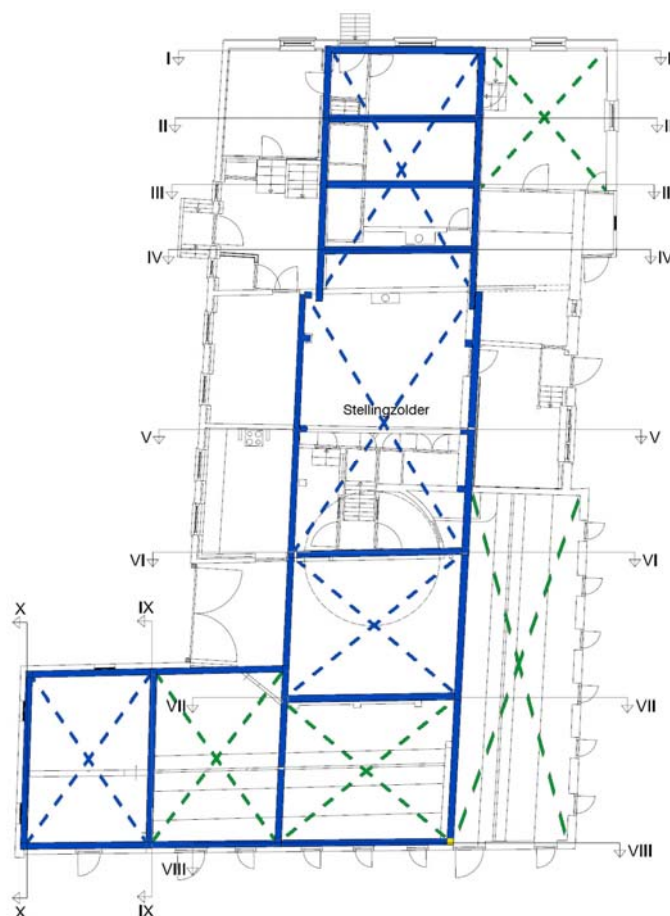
Waardestelling in plattegrond (incl. plafondafwerking).
